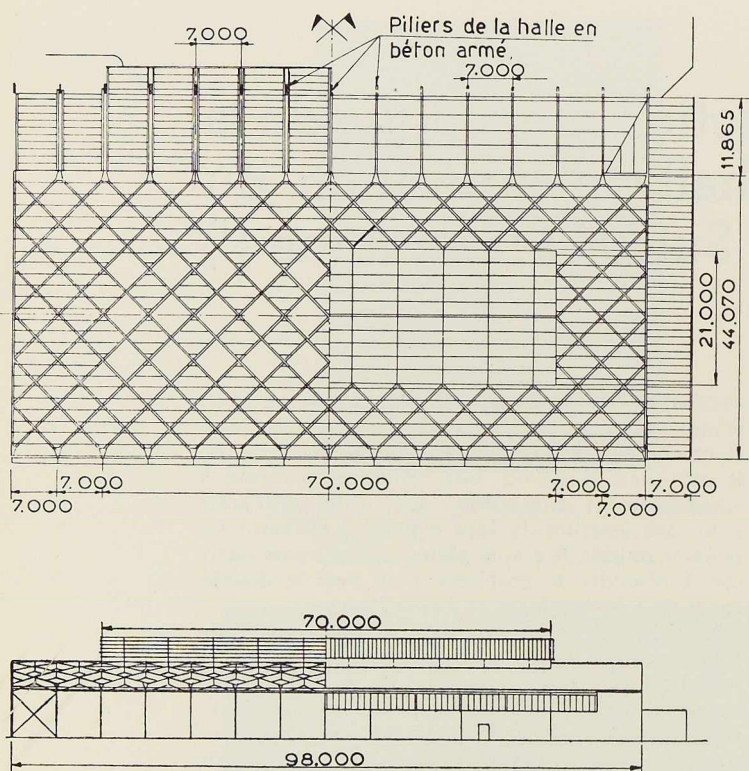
Plan général de la charpente métallique et coupe longitudinale.
